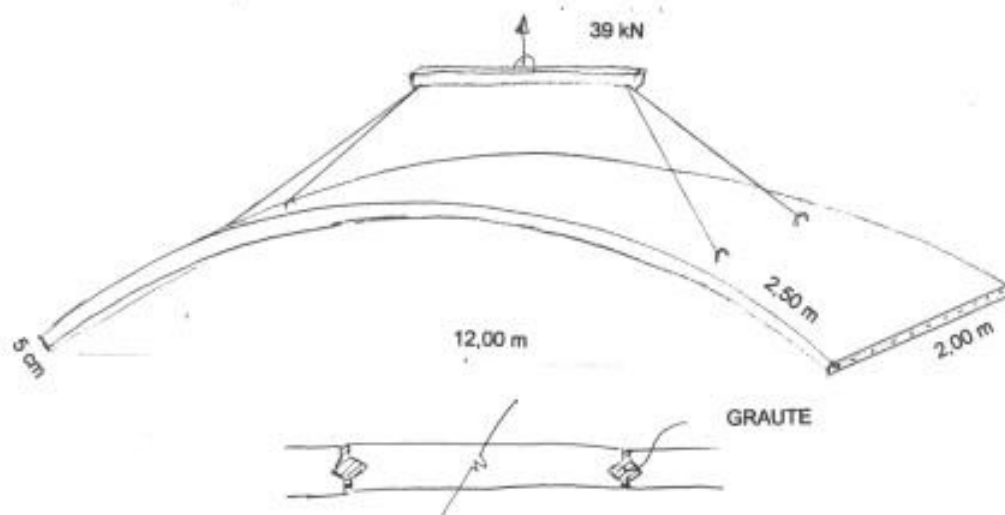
Elemento pré-fabricado para cobertura do túnel Rebouças (projeto)
